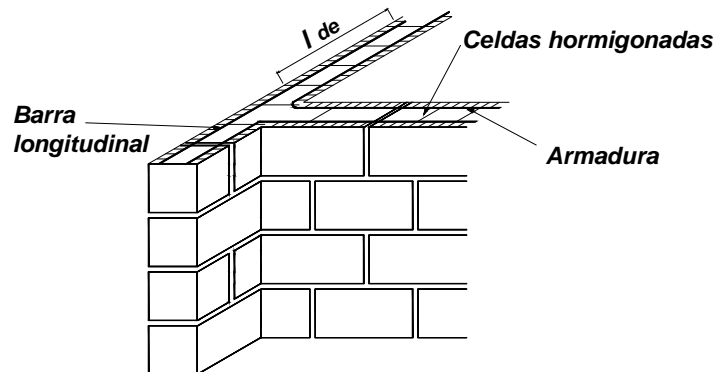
Armaduras de anclaje en encuentros de muros.
